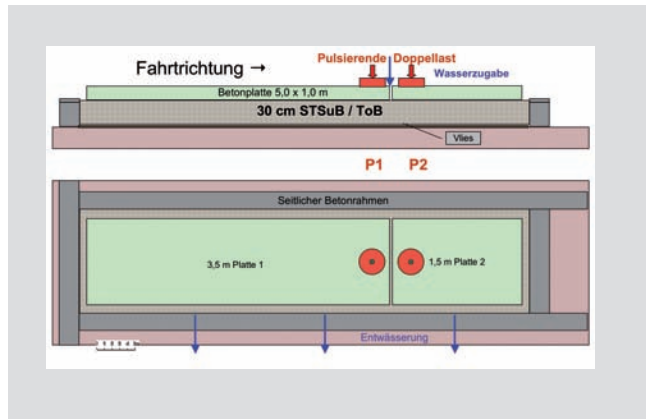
Großprüfstand für Versuche mit STSuB / ToB unter Betondecke (Längsschnitt und Aufsicht)
